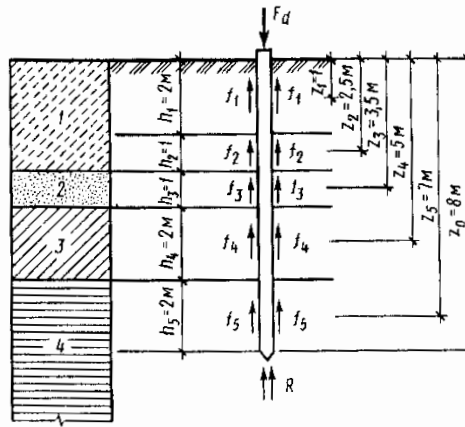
Расчетная схема к определению несущей способности сваи практическим методом
